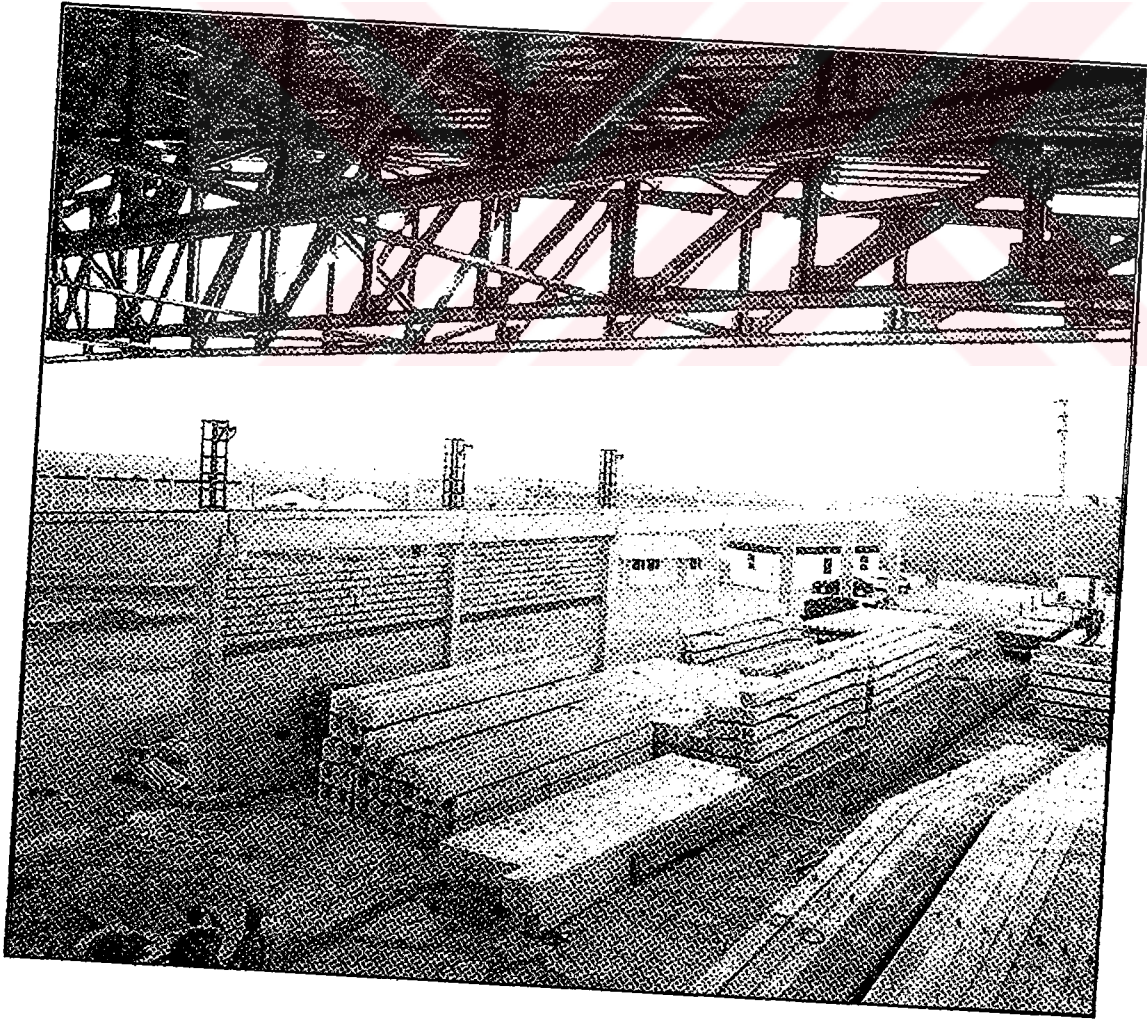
Diyar Prefabrik fabrika şeması
